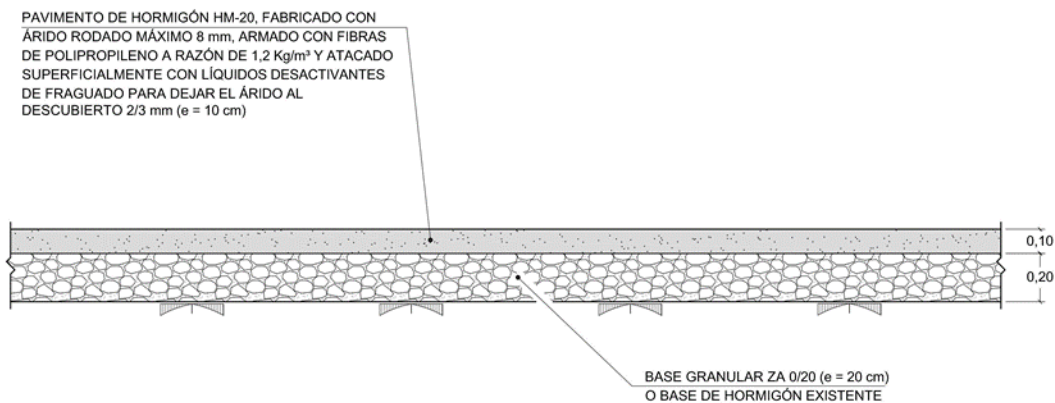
Detalle pavimento de hormigón desactivado. Fuente: Elaboración propia.
